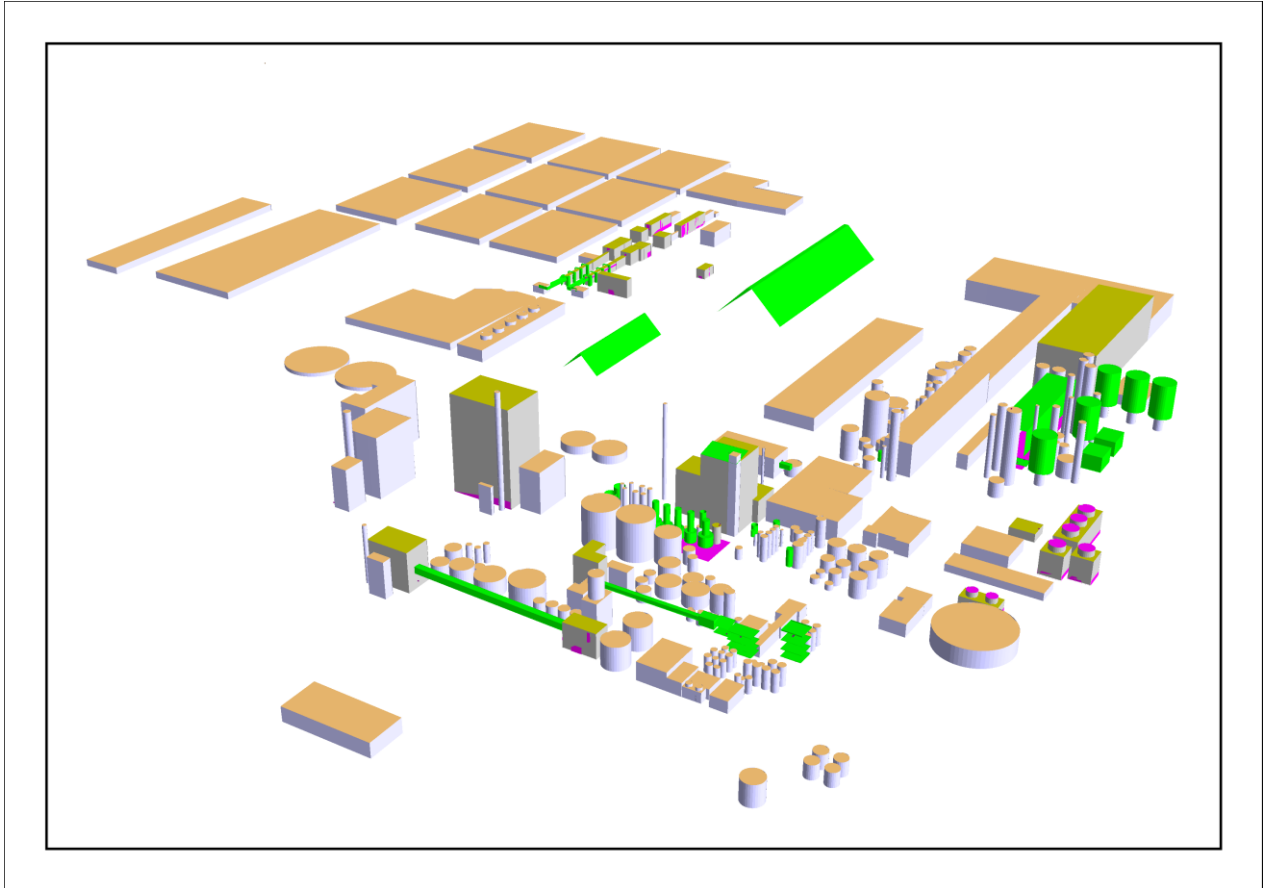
Vista isométrica de levantamiento planta Santa Fe. Vista sur-este.
